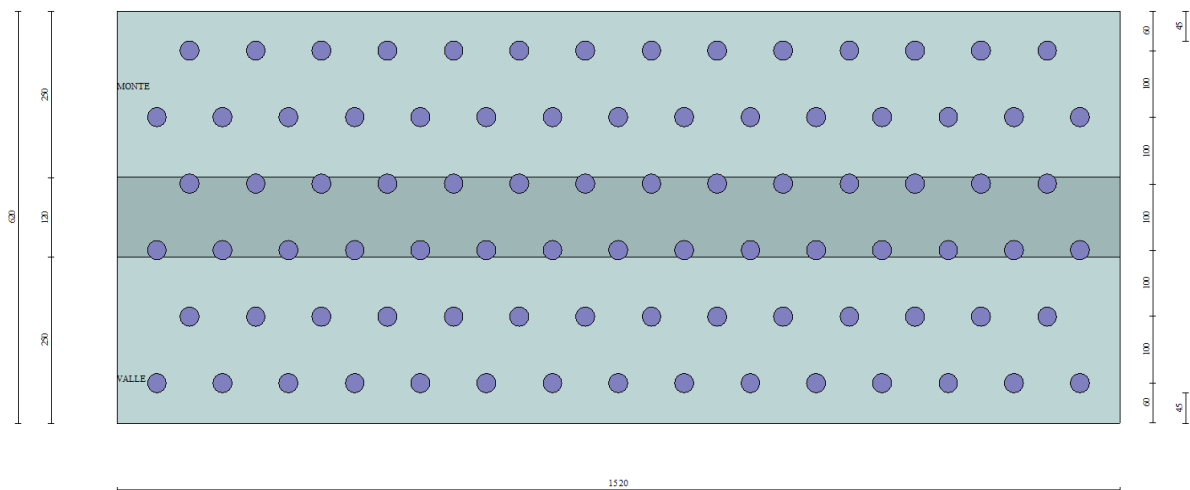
Muro Tipo A: disposizione dei micropali di fondazione.
